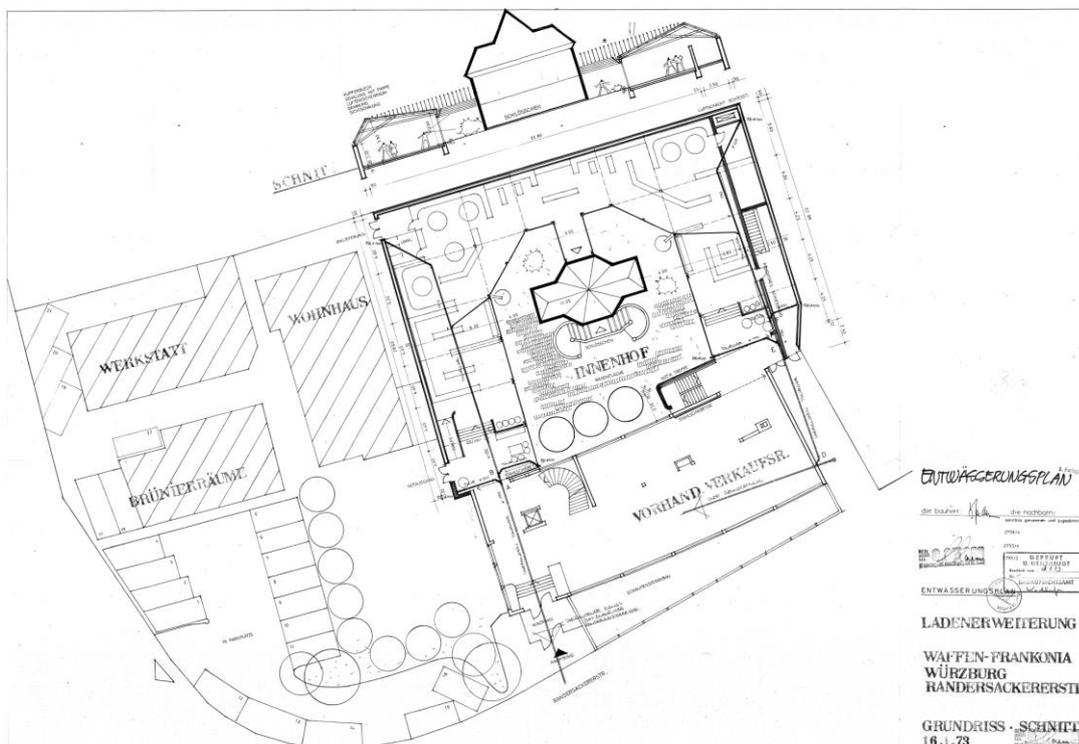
Ladenerweiterung, Grundrisse und Schnitt, Entwässerungsplan, Architekturbüro A. Amann, 16.1.1973.
